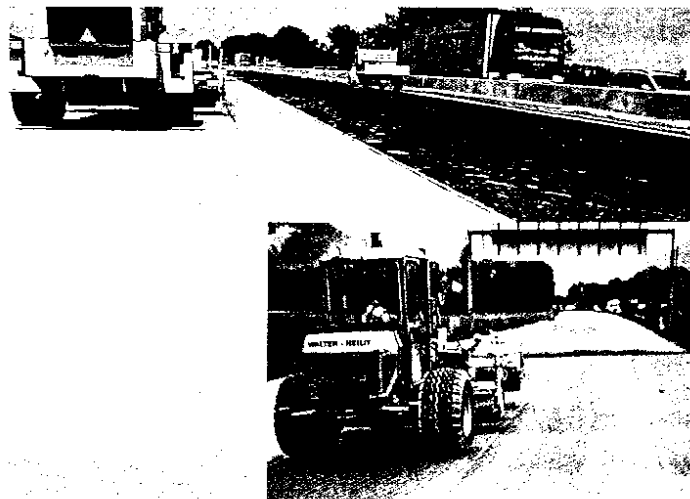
Herstellung einer Betonfahrbahndecke mit „Österreichischer Waschbetonoberfläche“: Abbürsten des noch nicht erhärteten Oberflächenmörtels.
